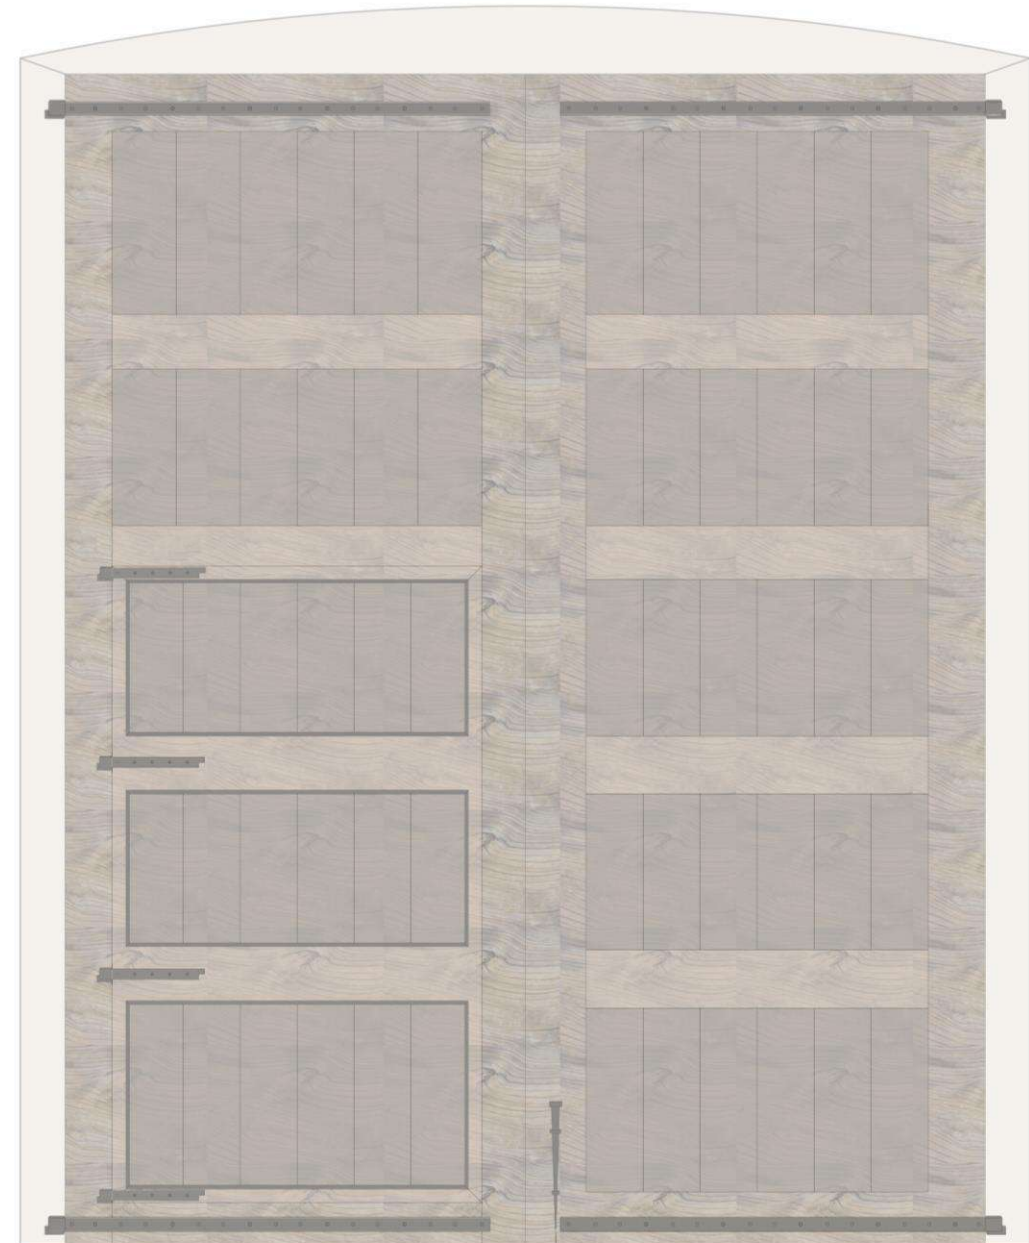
Detalle puerta de acceso a la vivienda. Fuente: Elaboración propia
